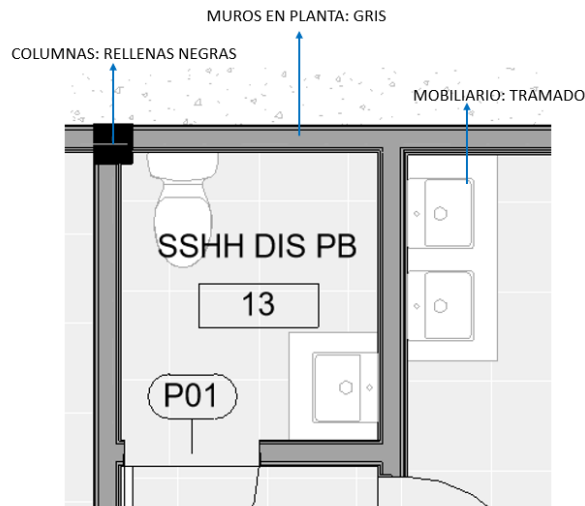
Ejemplo aplicación de plantilla de planta. Proyecto CMS
